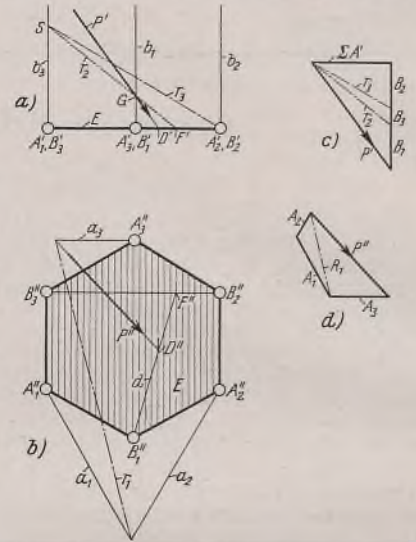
a u. b. Auf- und Grundriß des Fachwerks. Bild 4 c u. d. Kräfteplan für Auf- und Grundriß.
